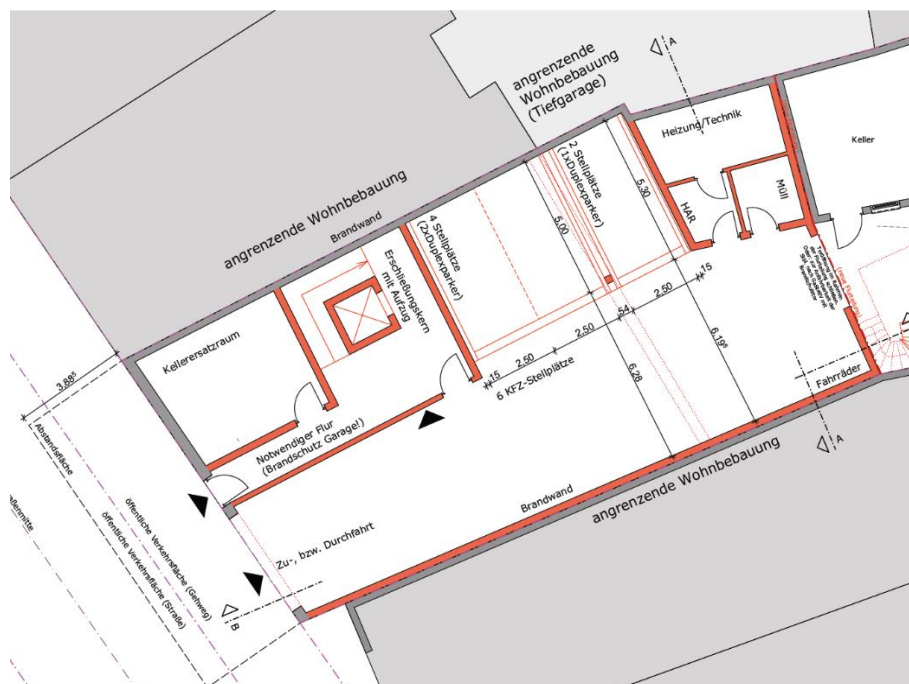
Erdgeschoss mit Zu-/Durchfahrt, Stellplätzen, Technik u. Nebenräumen Voranfrage, [REDACTED] v. 08.12.2025
